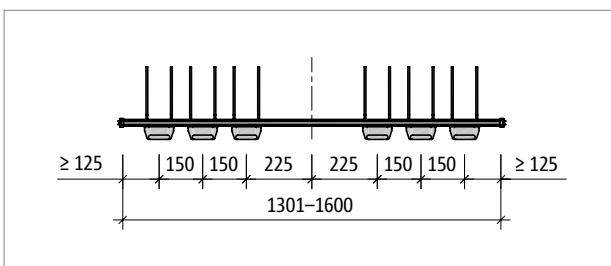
Schöck Tronsole® typ T-V4...-L1301 až L1600: Půdorys prvku
